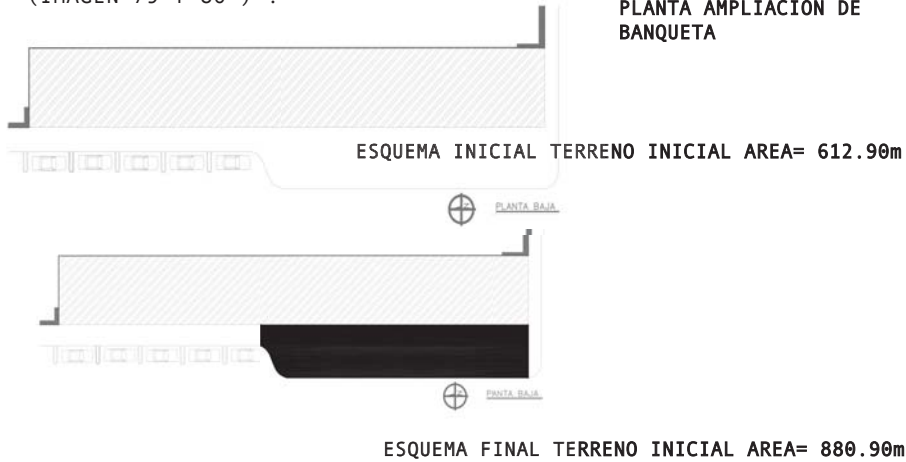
PLANTA BAJA DE LA CASA DE CULTURA
